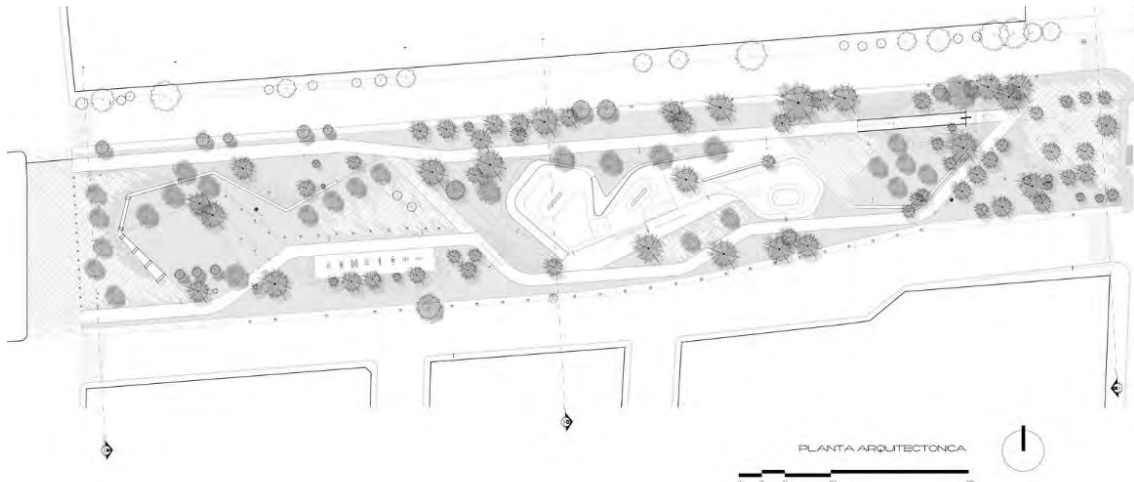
Planta Arquitectónica Canal Interceptor Tramo 2.
